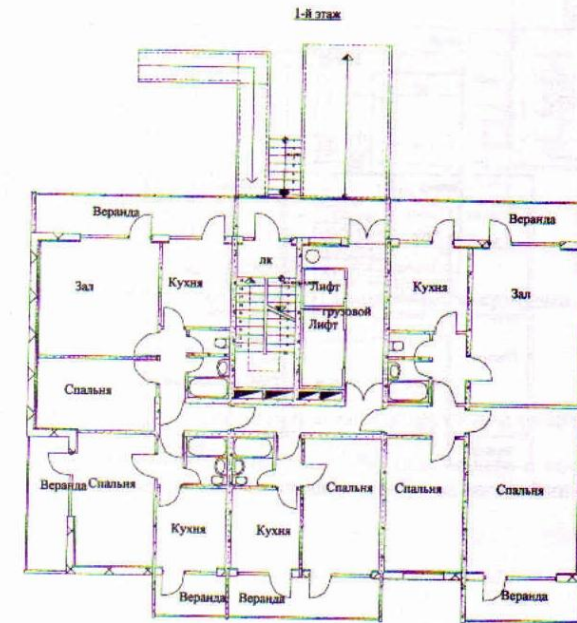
Односекционный жилой дом (1-1-2-3) комнатными квартирами. План 1-го этажа
